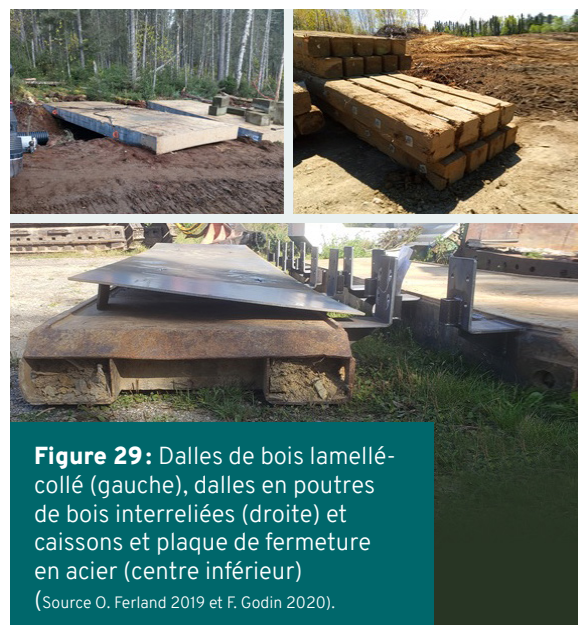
Dalles de bois lamellé-collé (gauche), dalles en poutres de bois interreliées (droite) et caissons et plaque de fermeture en acier (centre inférieure)
